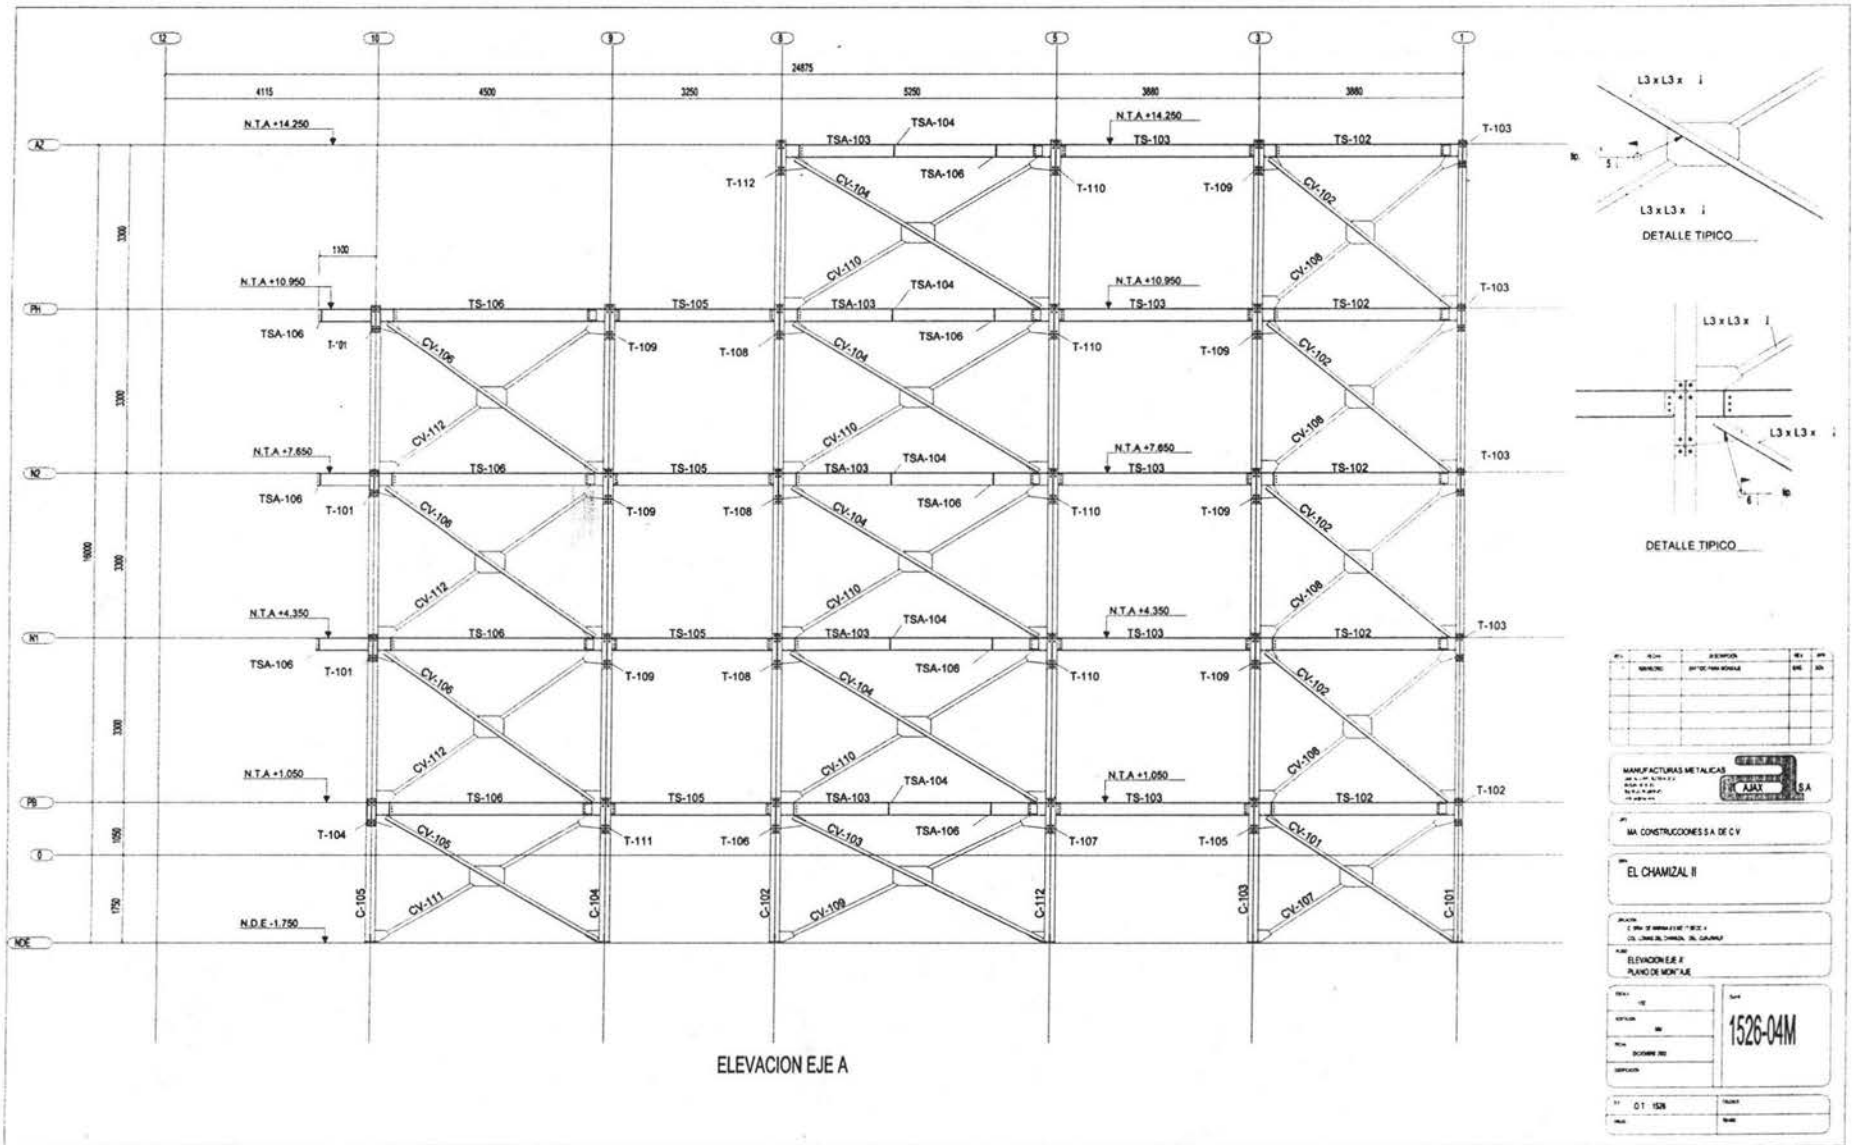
Indicación de soldadura de campo para contravientos.
